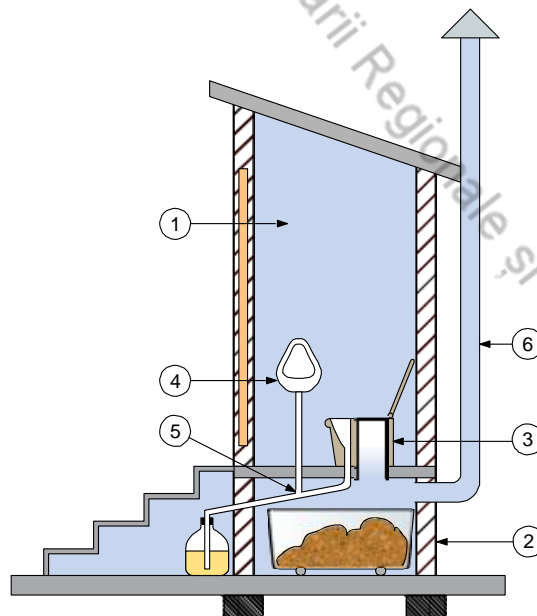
Общая схема СТOM. Основные элементы: 1) надстройка СТOM; 2) цокольное помещение СТOM; 3) унитаз типа Экосан; 4) писсуар; 5) трубопровод для отвода мочи; 6) вентиляционная система.
